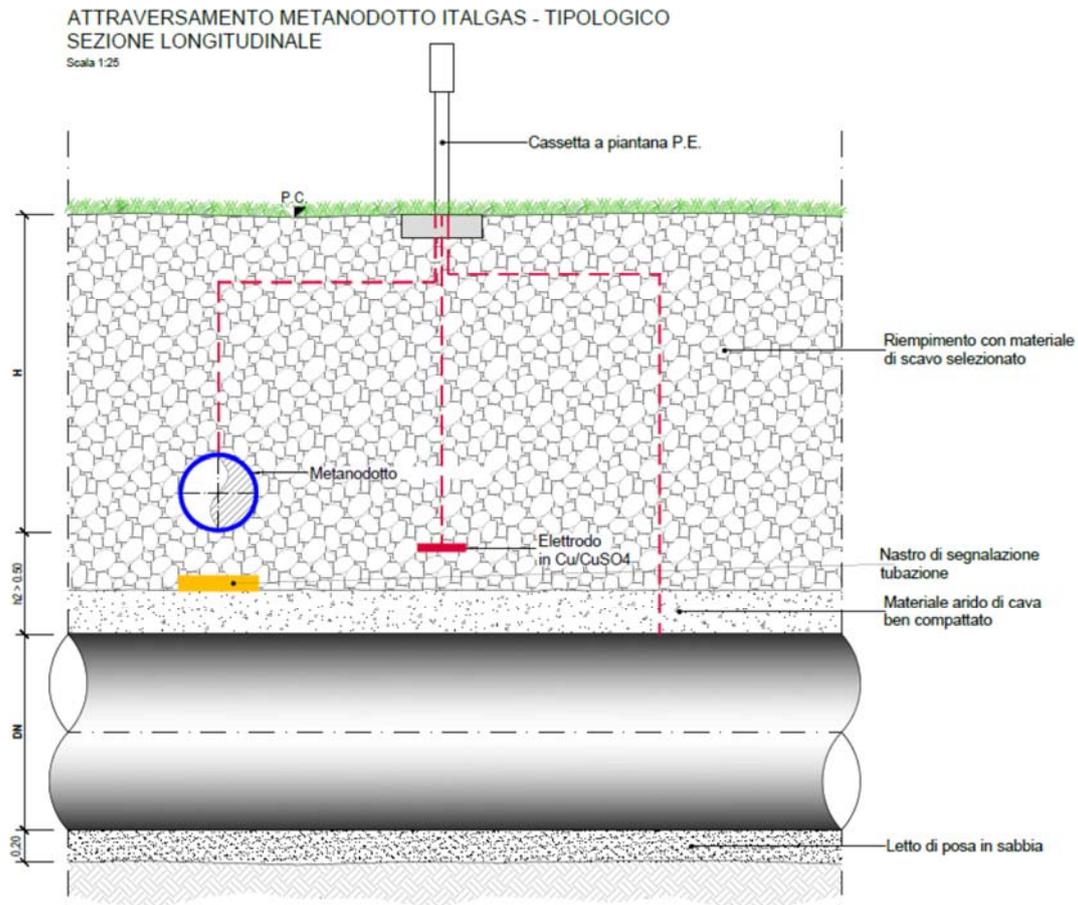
Sezione tipologica longitudinale di attraversamento.
